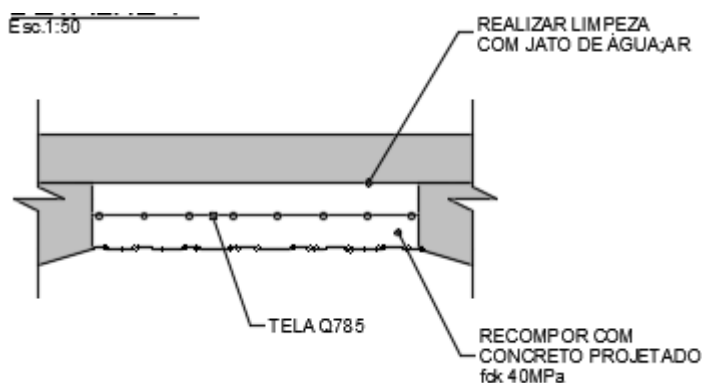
Recuperação do Tabuleiro – Ponte de Acesso – Lajes com armaduras expostas
